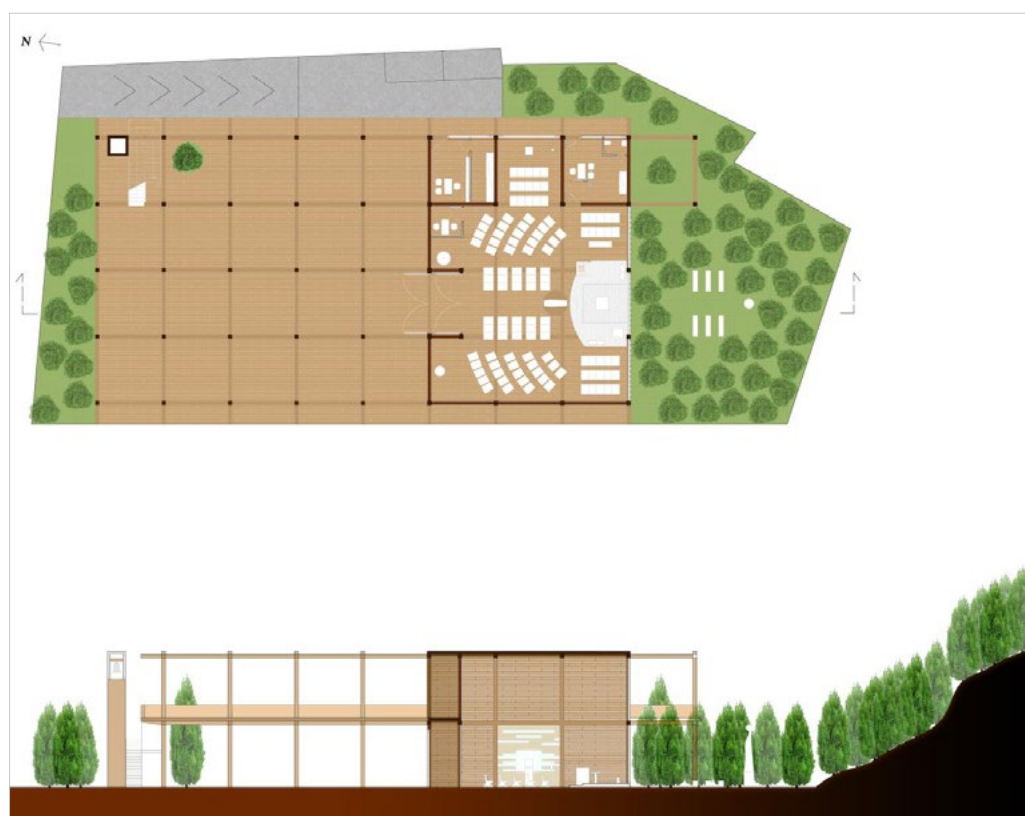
Un traliccio tra città e giardino. Cappella temporanea per Ussita (MC). Pianta e sezione longitudinale (fonte: M. Astone).
